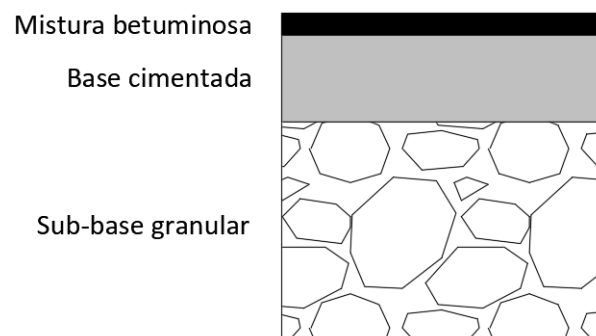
Constituição do pavimento semi-rígido. Adaptado de (Gregorio, 2016)
